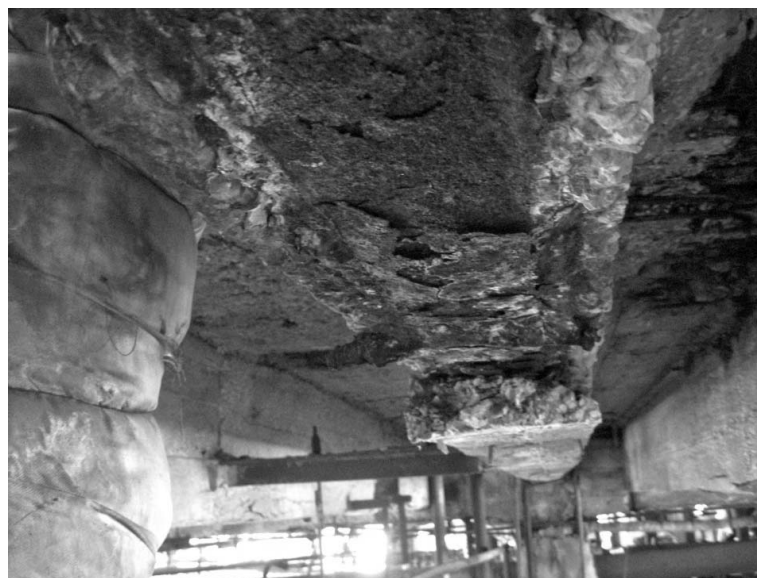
Фрагмент коррозионного разрушения балки перекрытия на отм. 4,8 м
